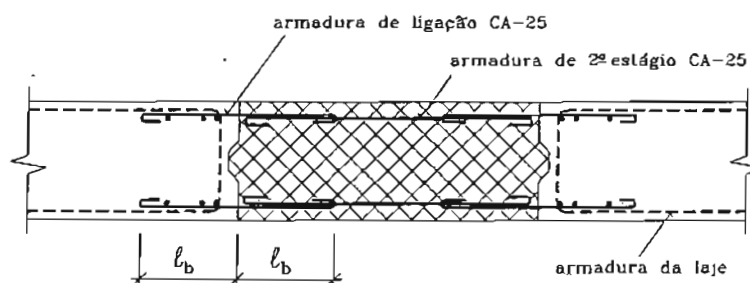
Detalhe de armadura para abertura temporária em laje
